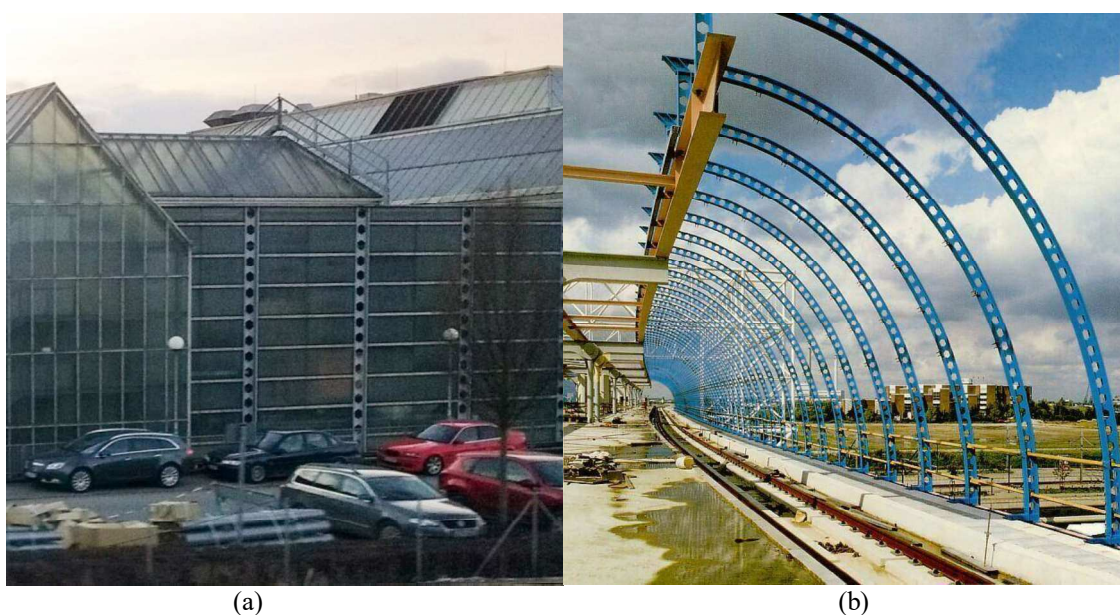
Perfis castelados utilizados como pilares: (a) edifício em Stuttgart; (b) estação ferroviária em Amsterdam.
